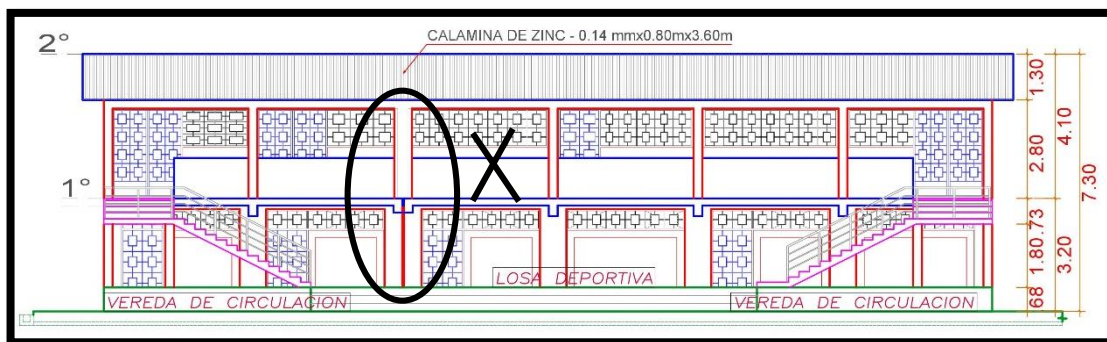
Plano de elevación frontal _Módulos IV y VIII; desaparece junta sísmica en el 2° piso.
